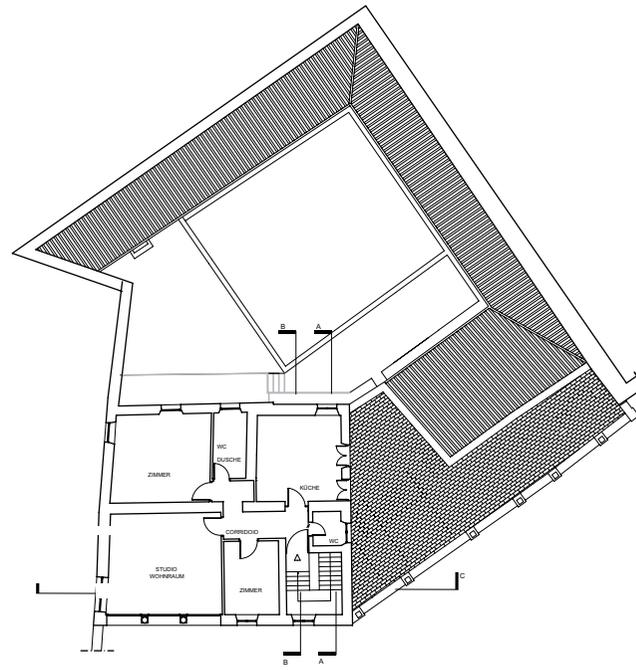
Grundriss Villino OG
